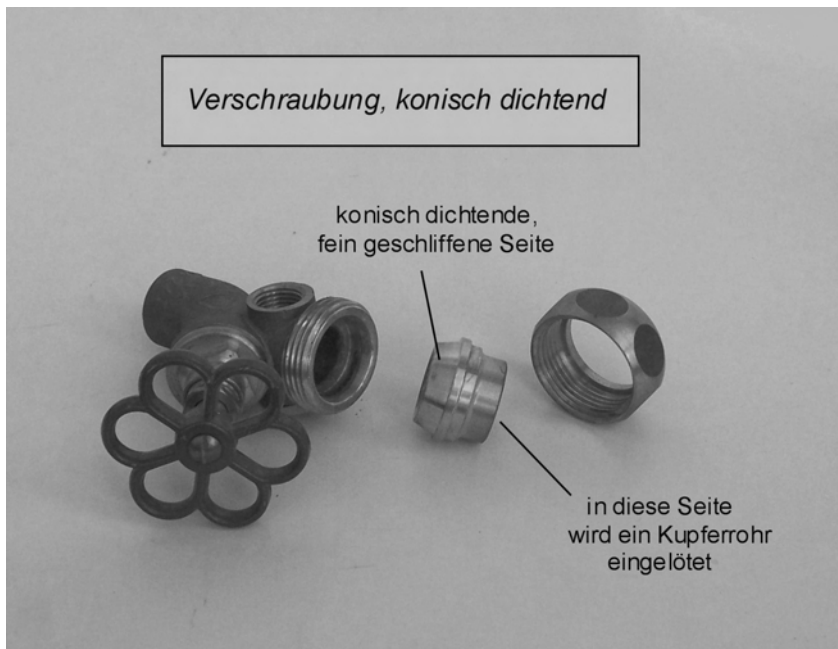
Ausführungsbeispiel eines Ventils mit konisch dichtender Verschraubung
